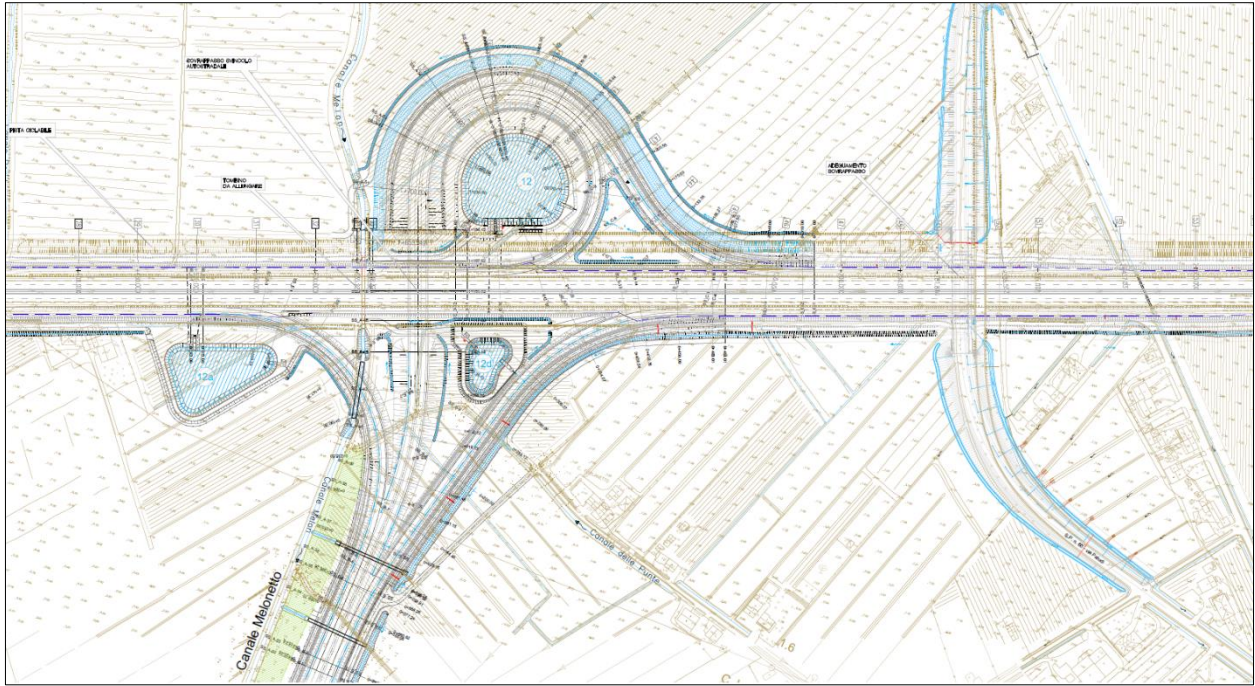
Stralcio della planimetria del nuovo svincolo di San Stino di Livenza
